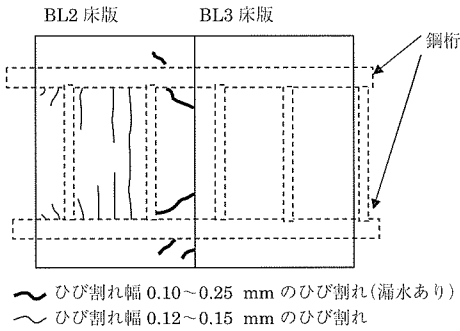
BL2 床版下面部ひび割れ概要図
